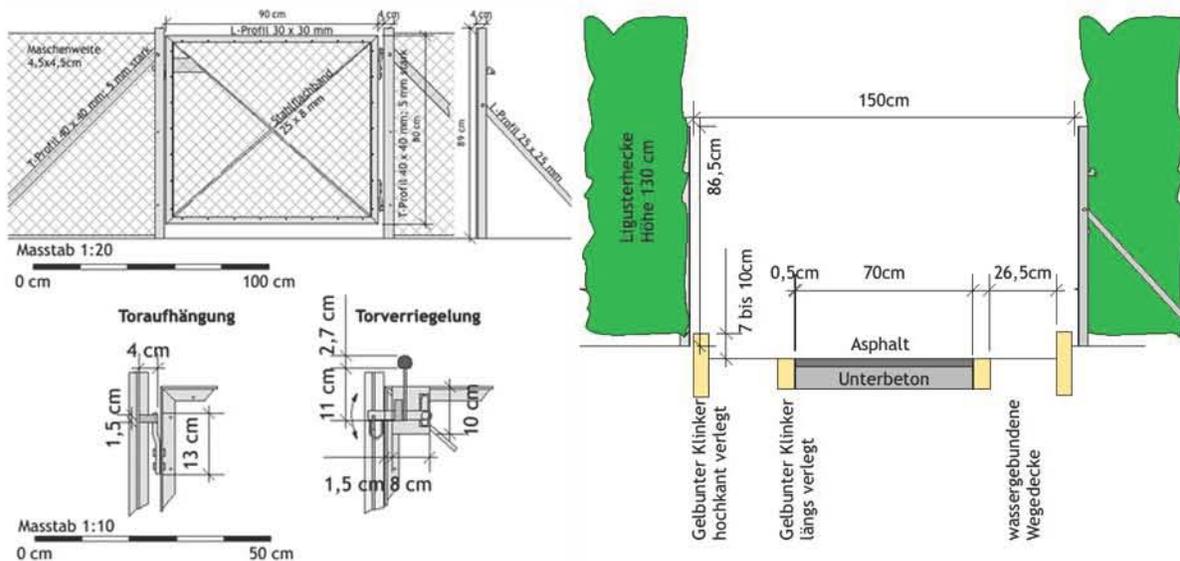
detalles constructivos para realizar intervenciones en ventanas, fachadas y cancelas del Hufeisensiedlung, esta información es desarrollada y aplicada por la unidad de gestión. Archivos tomados de <http://hufeisensiedlung.info/>
